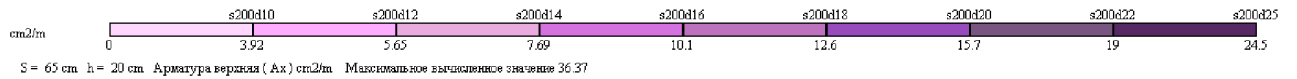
Площа арматури на 1 м.п по осі X у верхньої грані
